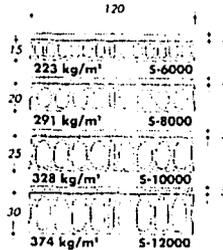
Secciones transversales típicas de losas extruidas alveolares.
